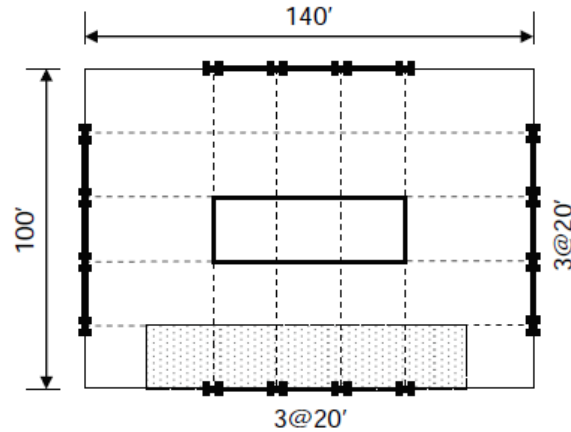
Configuración de planta de pórticos tipo SMF.
